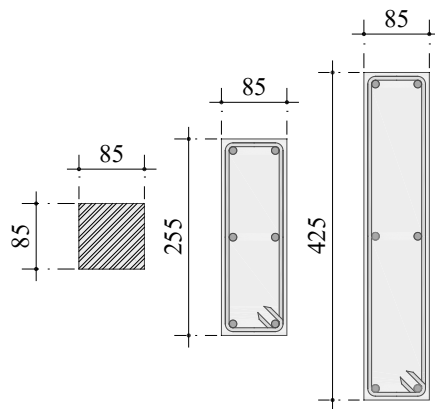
Seção e armadura dos pilares A, B e C (mm)
